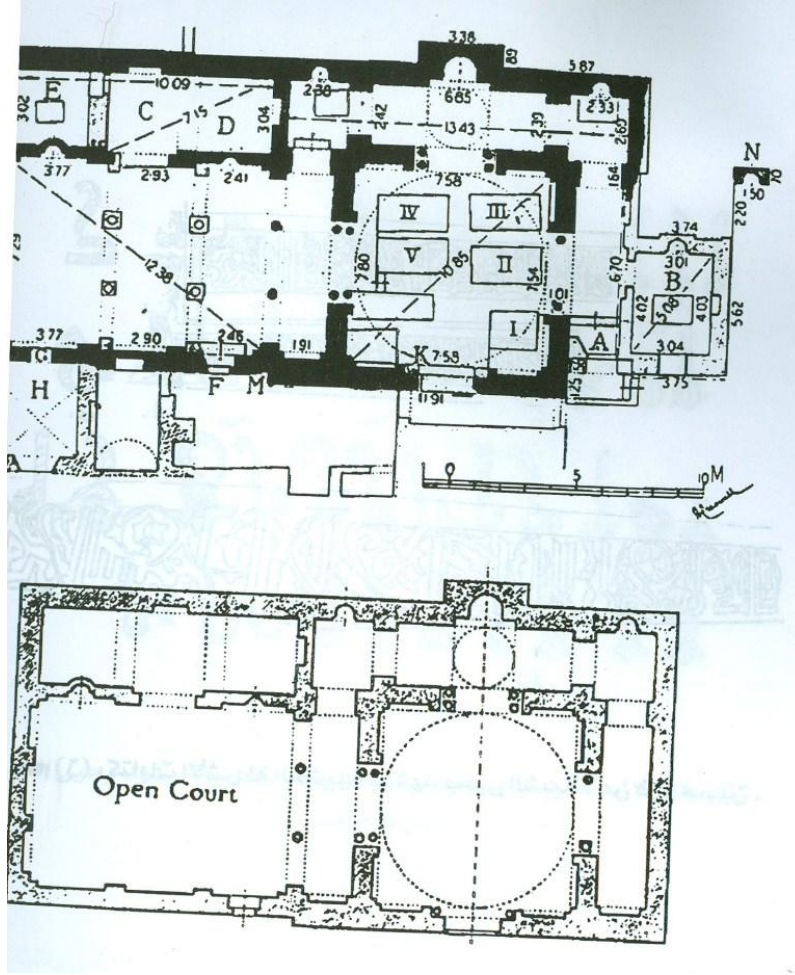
/3): مسقط أفقي لجامع المهديّة. عن: كريسويل
